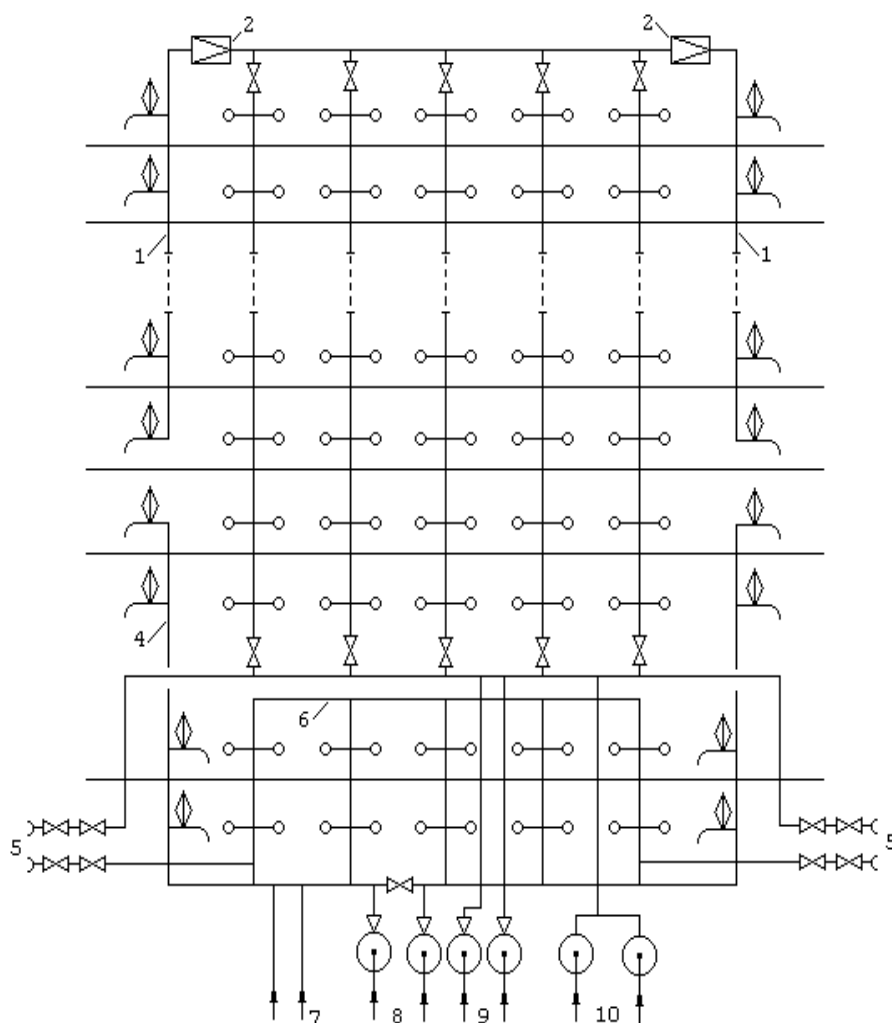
Схема объединенного водопровода 22-этажного здания
